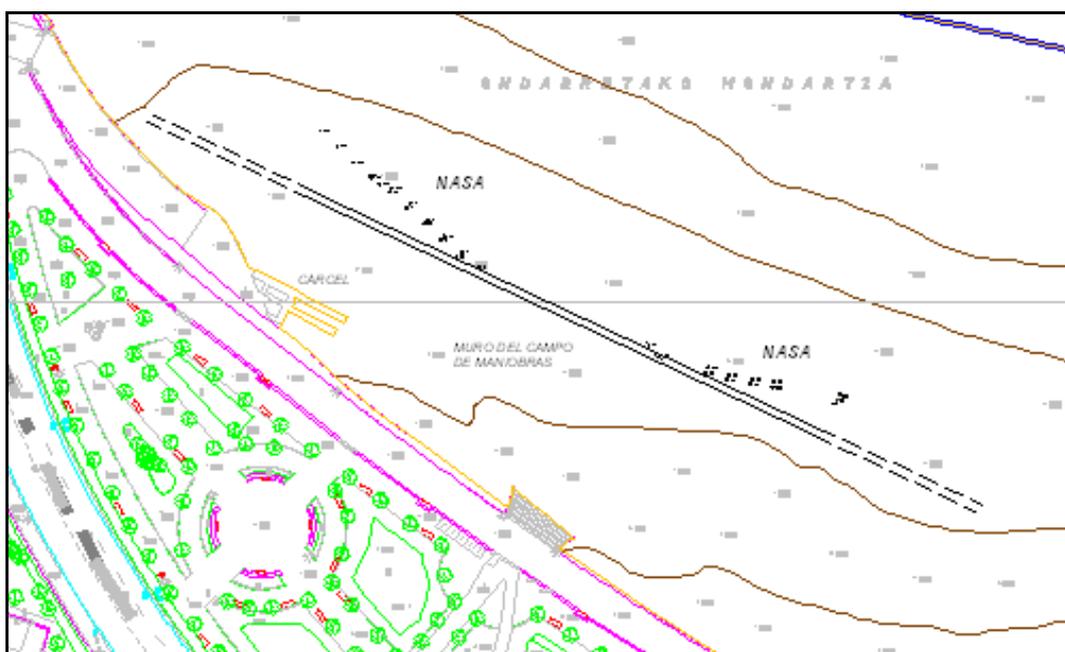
Planta de las estructuras (Alberdi, Pérez & Etxezarraga, 2005).
